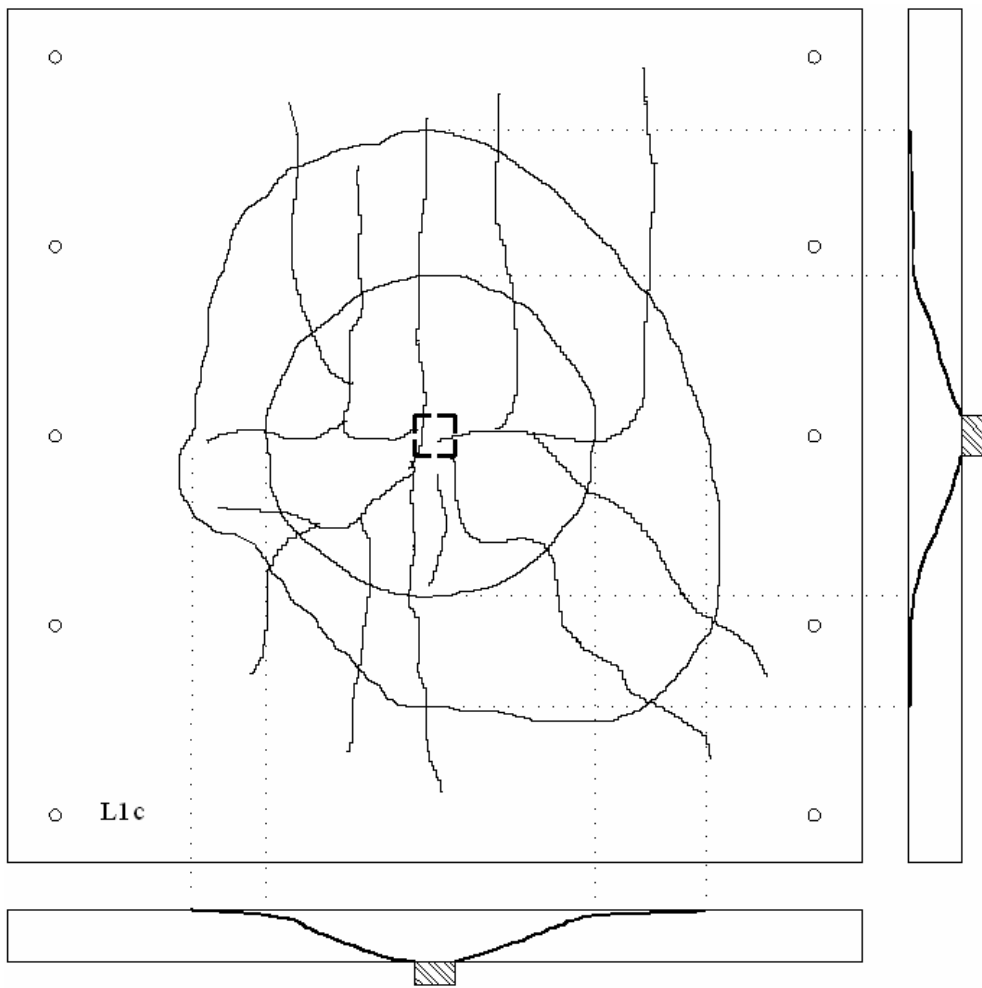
Mapa de fissuração da laje L1c
